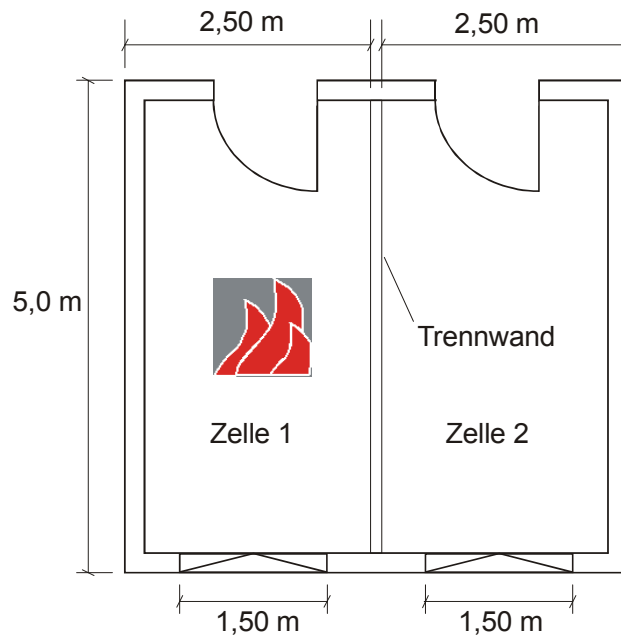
Grundriss eines Büros mit Raumzellen
